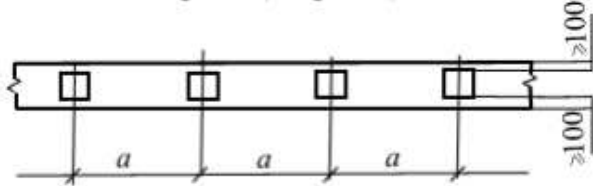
Схема расположения свай в рядовом фундаменте
